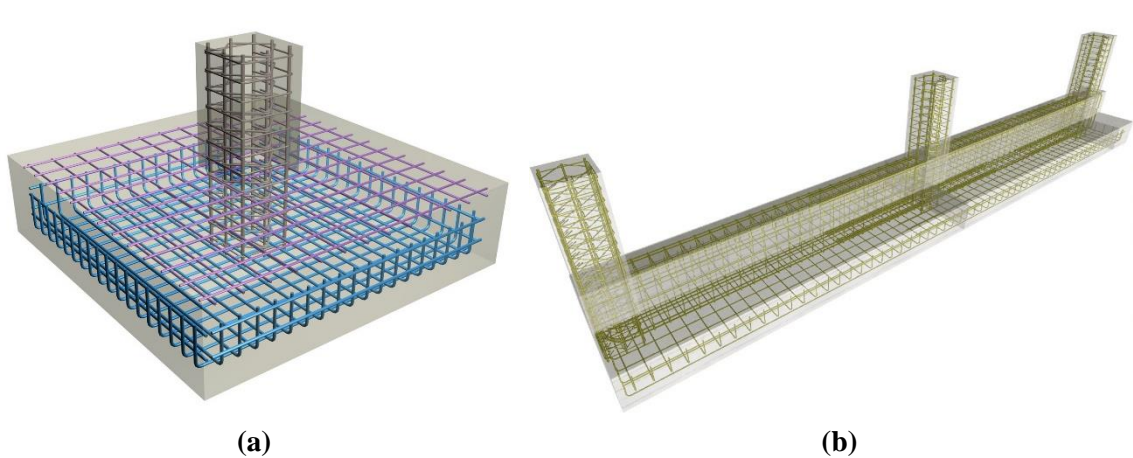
Ejemplos de cimentación flexible, a) zapata aislada, b) zapata corrida (Building How, 2015)
